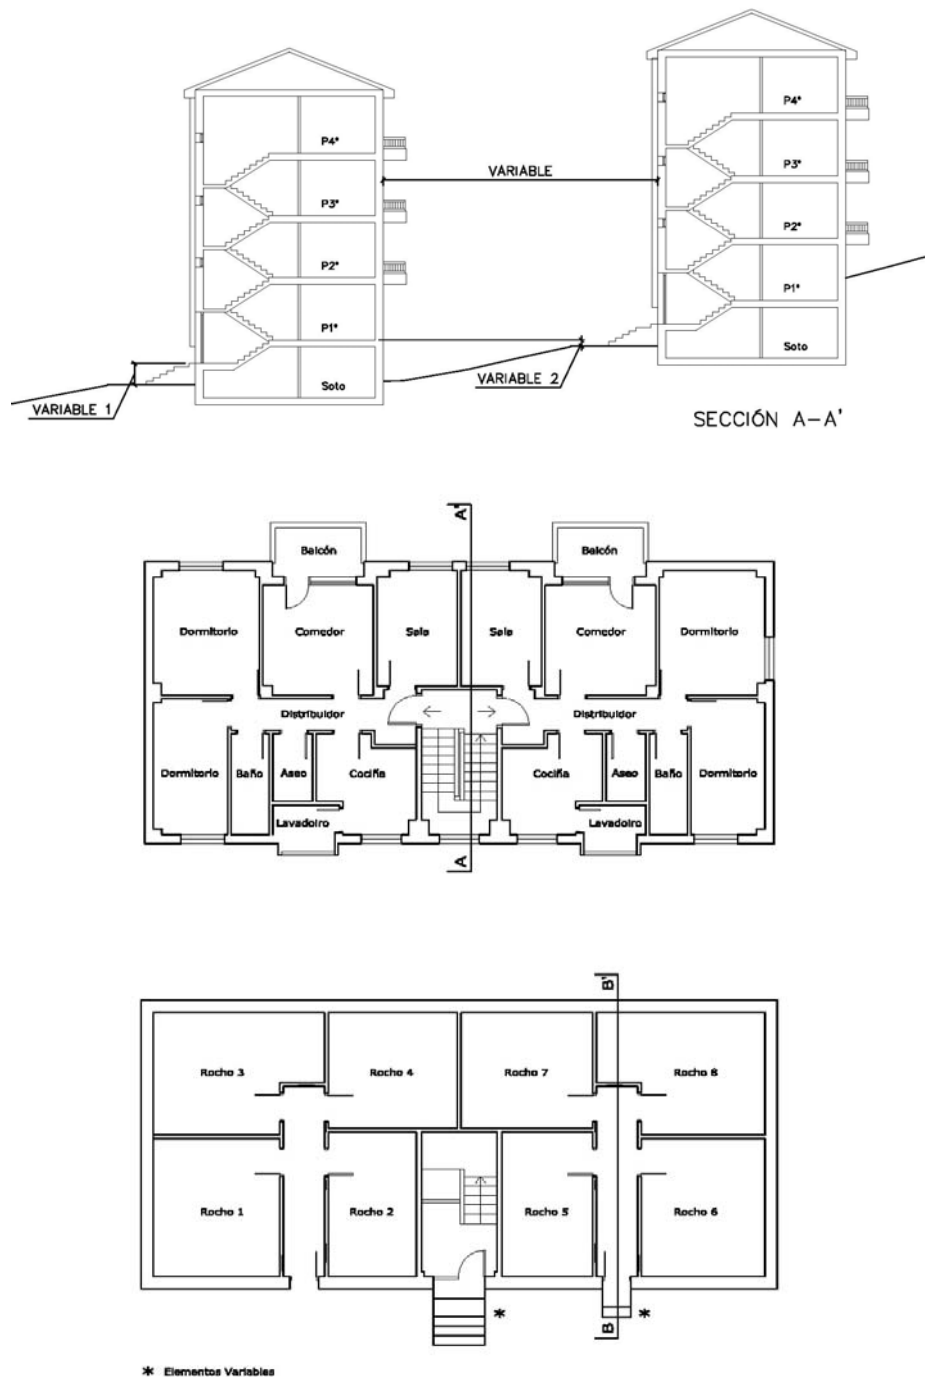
Planos de distribución de Planta Baixa e Plan Tipo e Sección da edificación.
